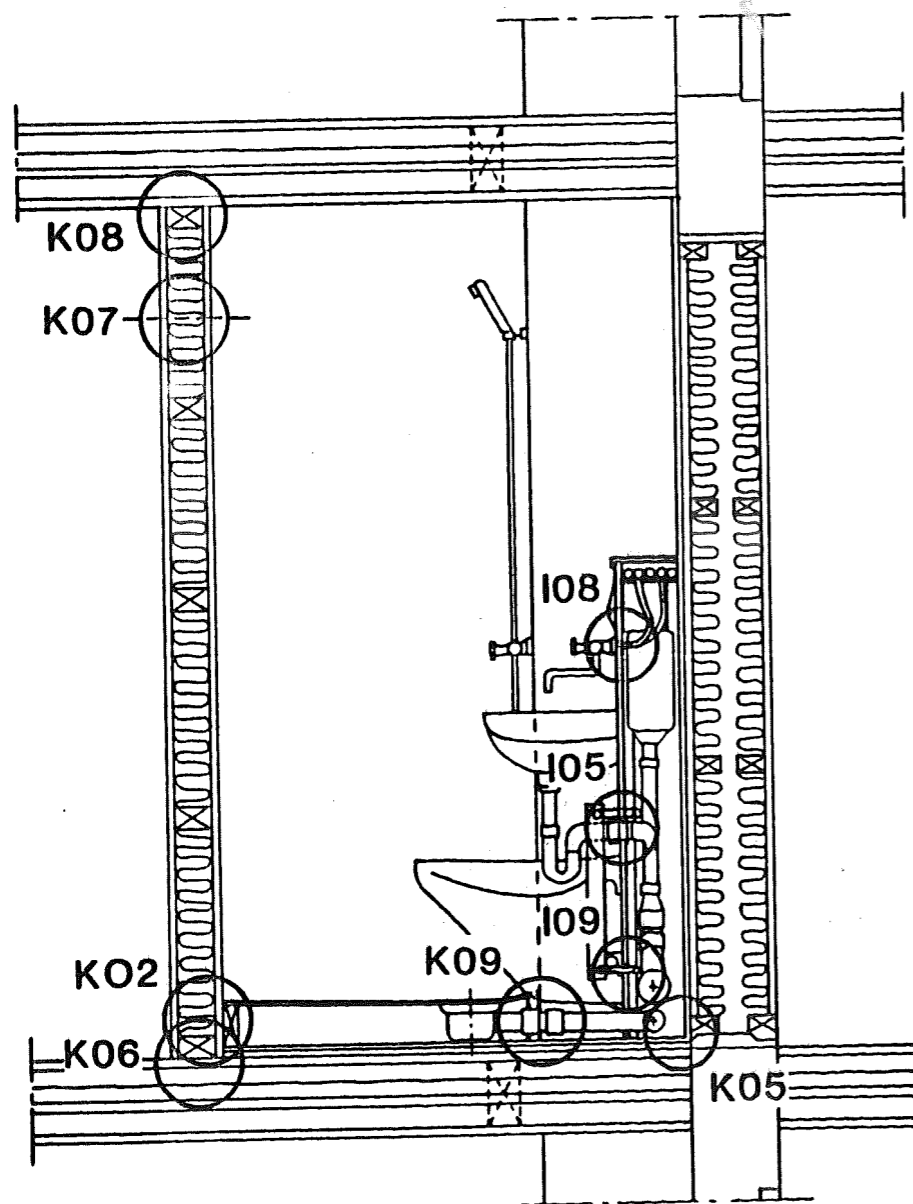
Boligplan med nyt baderum med installationspanel og ny basisinstallation. Mål 1:100.
